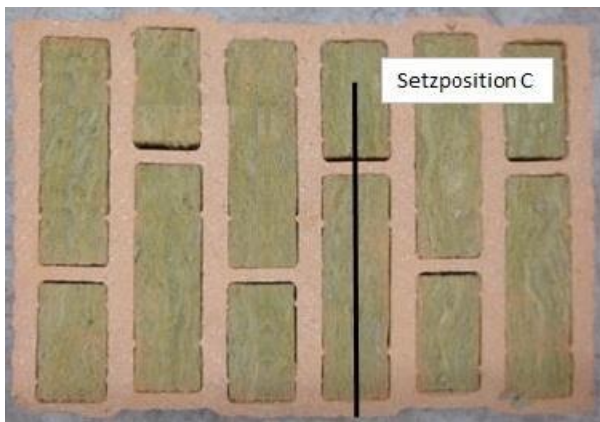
Setzpositionen der Dübel in wärmedämmenden PlanHLz
